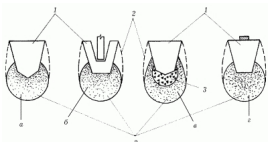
Устройство фундаментов в вытрамбованных котлованах: а – способом заполнения бетоном в распор (обычный фундамент); б – установкой сборного элемента (обычный фундамент); в – заполнением монолитным бетоном (фундамент с расширенным основанием); г – фундамент с расширенным основанием; 1 – фундамент в
